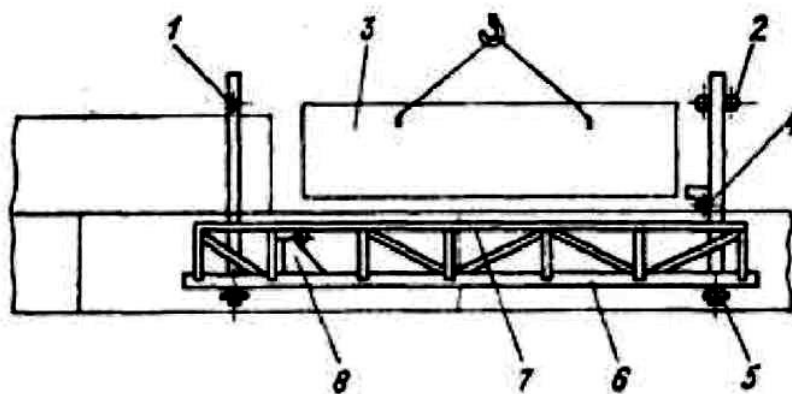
Навесные подмости для монтажной сварки вертикальной стенки резервуара
